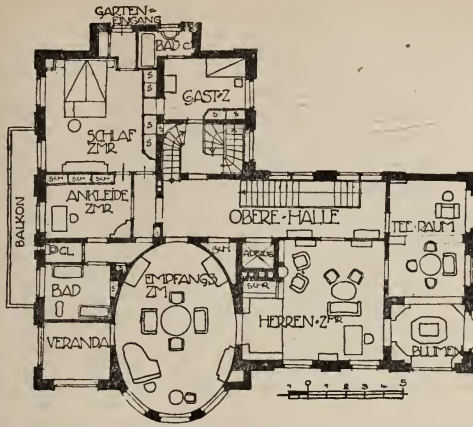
Größeres Haus mit langrundem Empfangszimmer
